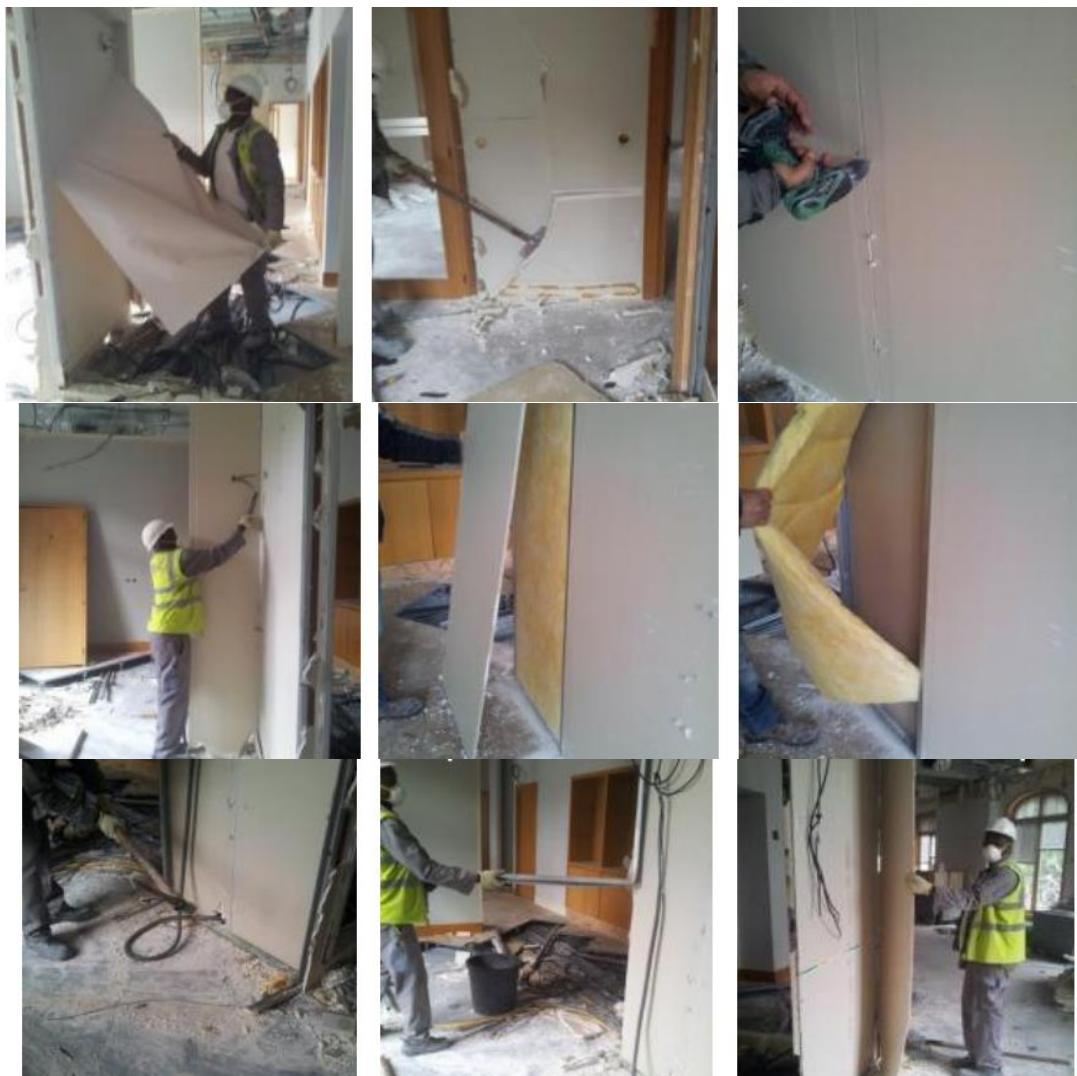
Desconstrução de parede dupla de *dry wall* com isolante
